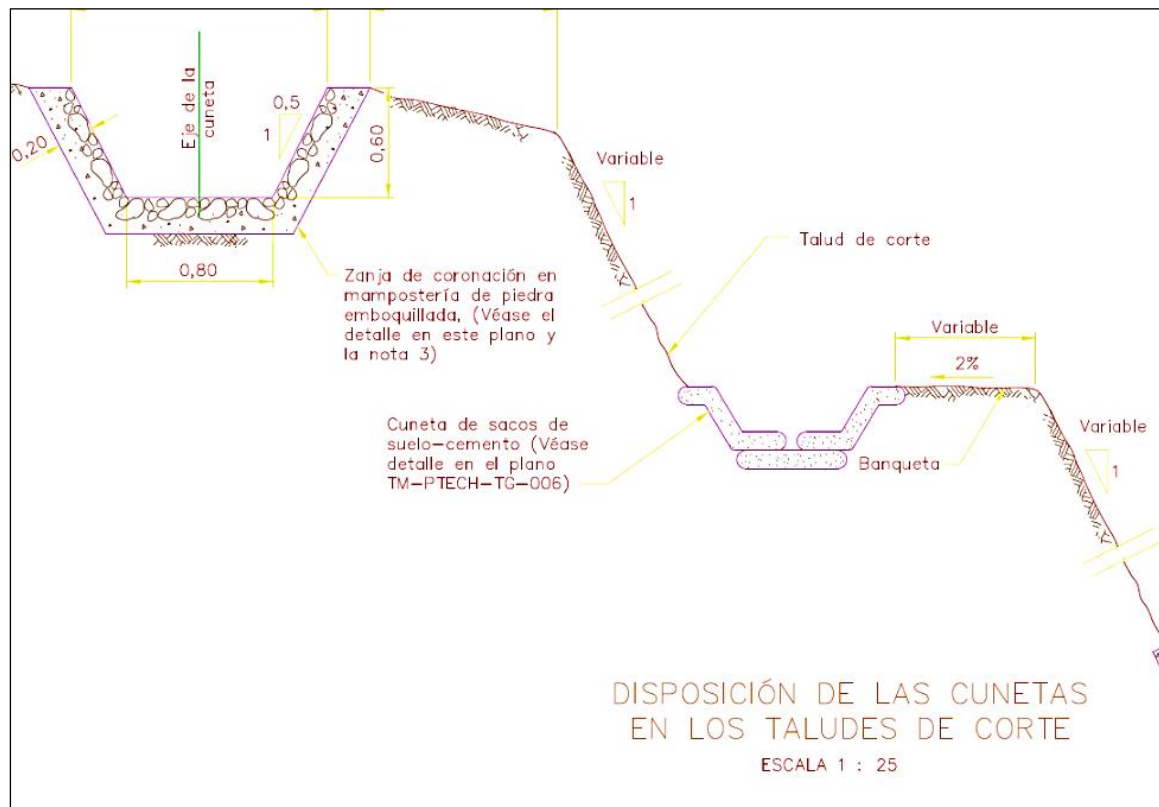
Cunetas en canal de coronación. Fuente. Elaboración propia
